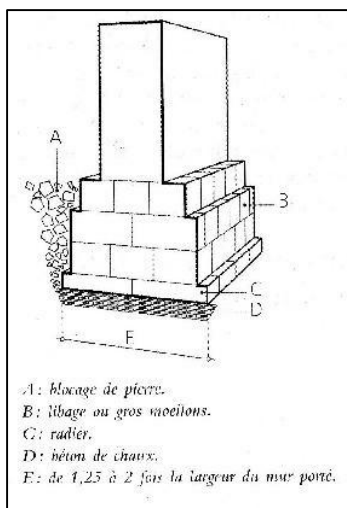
Fondation exceptionnelle en pierre sur un bon sol
